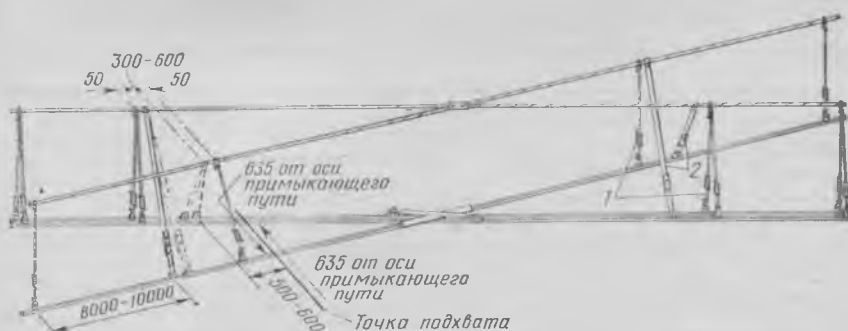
Воздушная стрелка с перекрестными струнами полукомпенсированной подвески: 1 — вертикальные капроновые струны; 2 — перекрестные жесткие распорки
